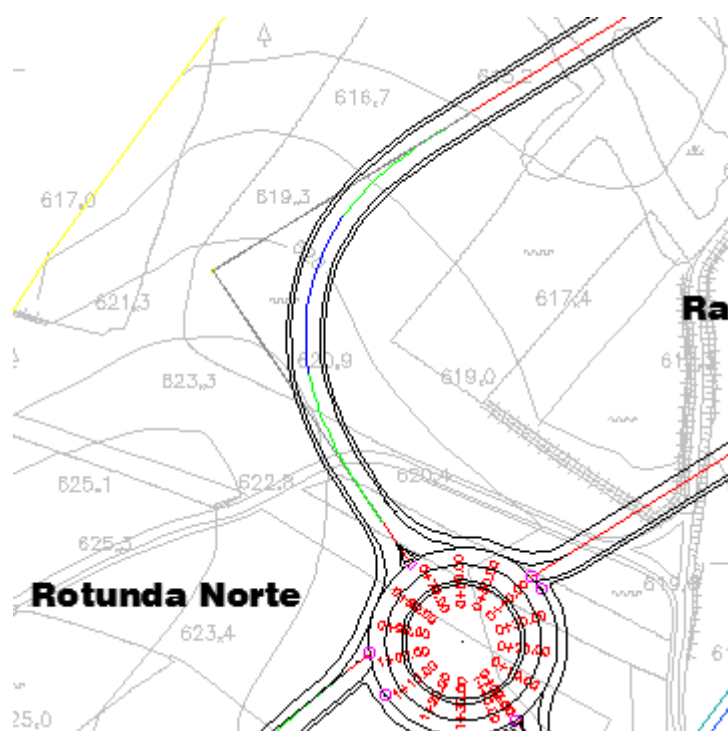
Pormenor da Planta do Ponto Inicial do Restabelecimento Norte
